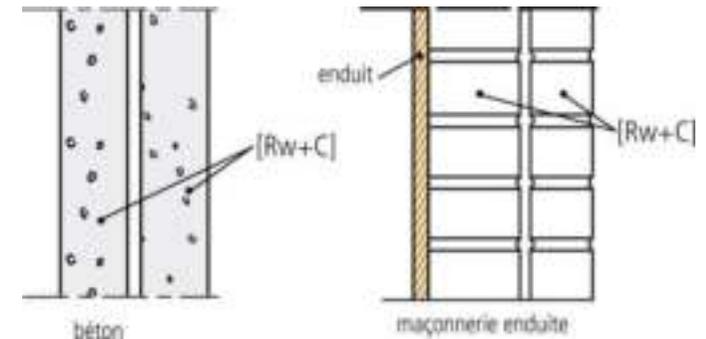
Parois verticales doubles en béton ou en maçonnerie enduite, non recouvertes d'un doublage.
